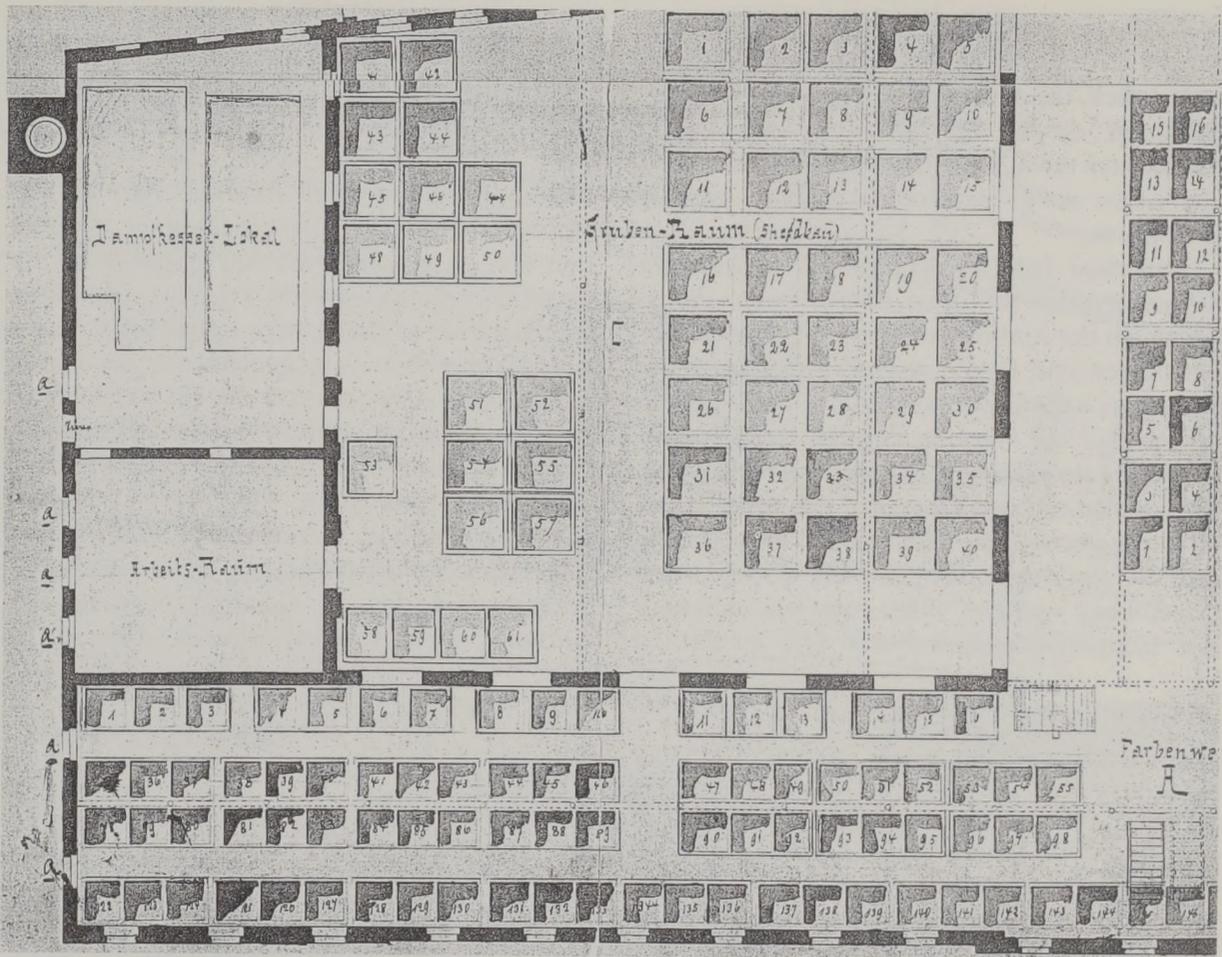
Ausschnitt vom östlichen Bereich des Erdgeschoss-Grundrisses mit der Anordnung eines Teils der 173 Farben, 61 Gruben, 16 Haspelfarben und einem Walkfass.
